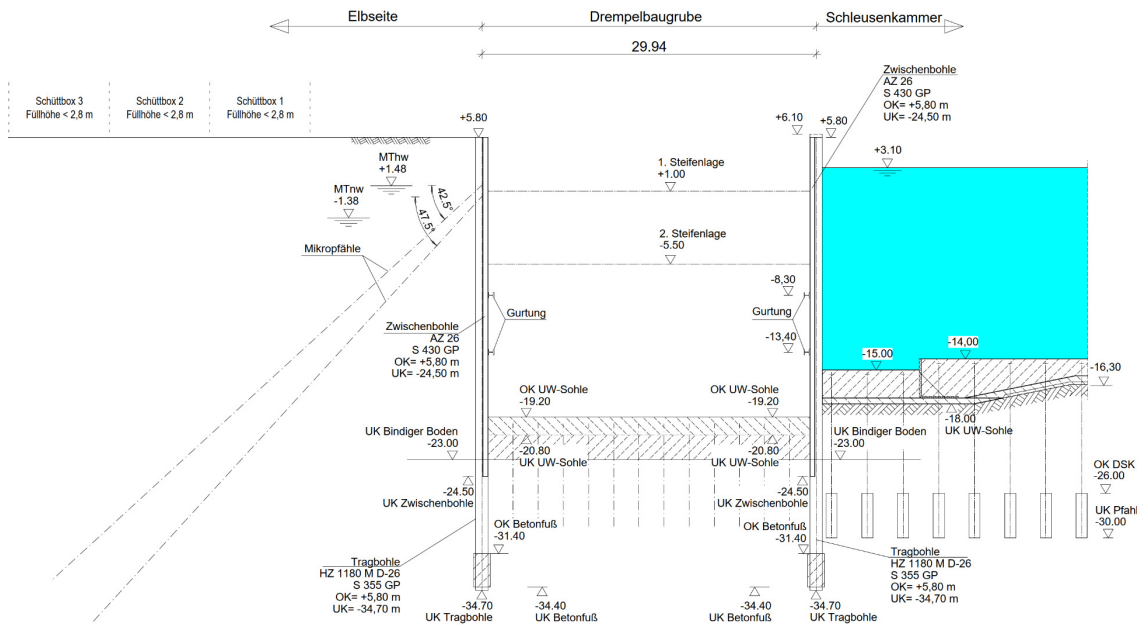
Schnitt 1-1, Drempelbaugrube Außenhaupt
